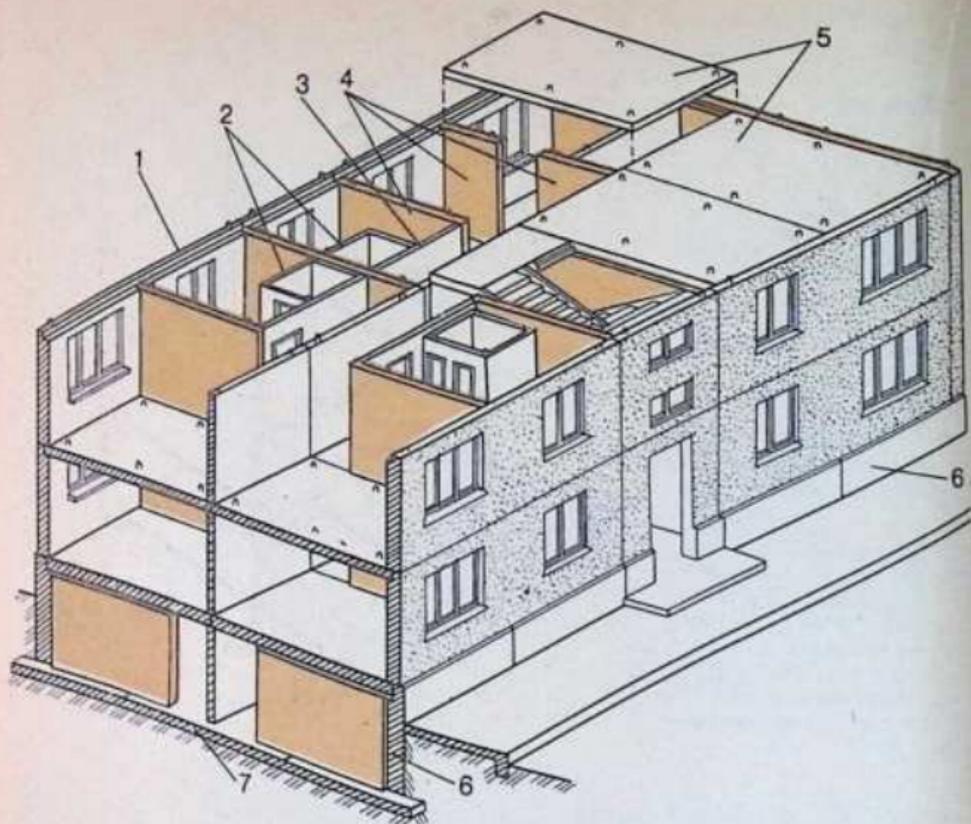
Конструктивная схема крупнопанельного дома с несущими стенами-перегородками:
